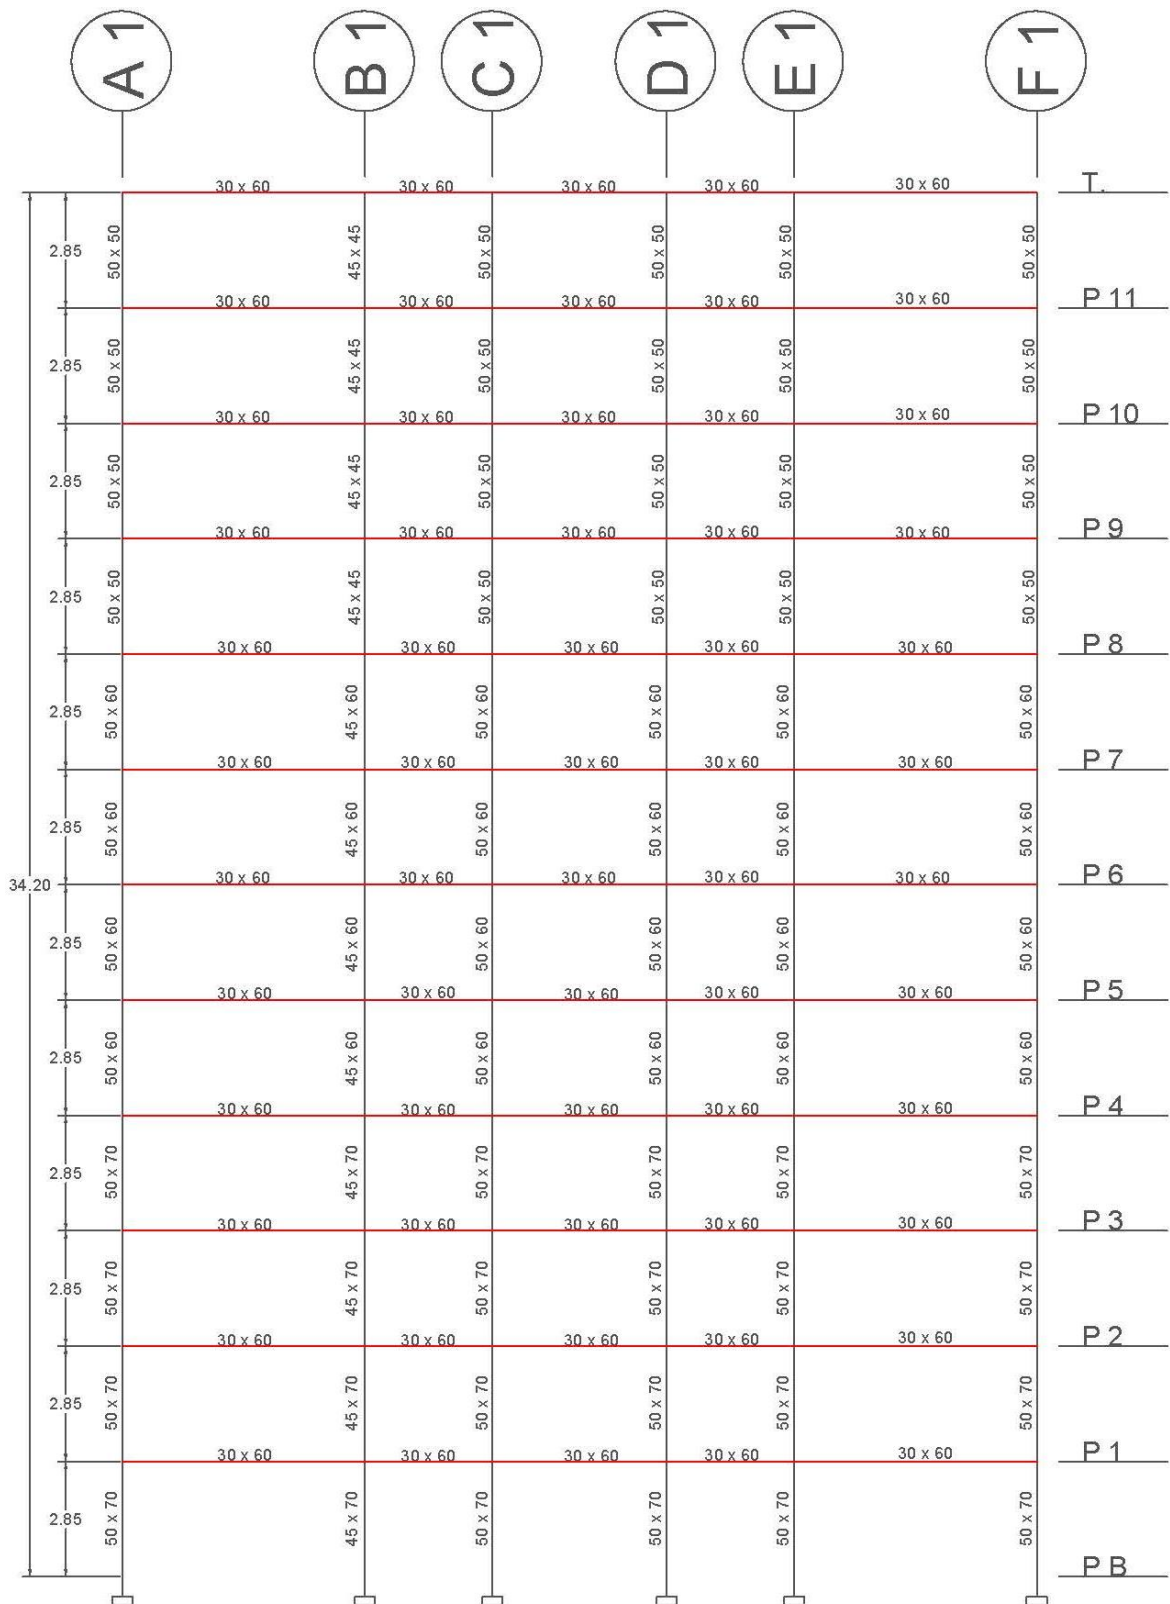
ELEVACIÓN DE PÓRTICO 1 Y 5
